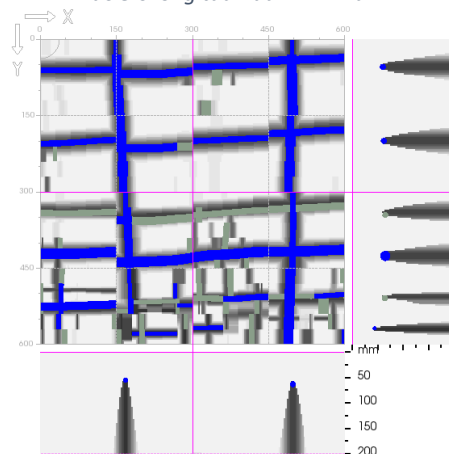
Poutre Pt04 – Travée 4 à mi-travée
